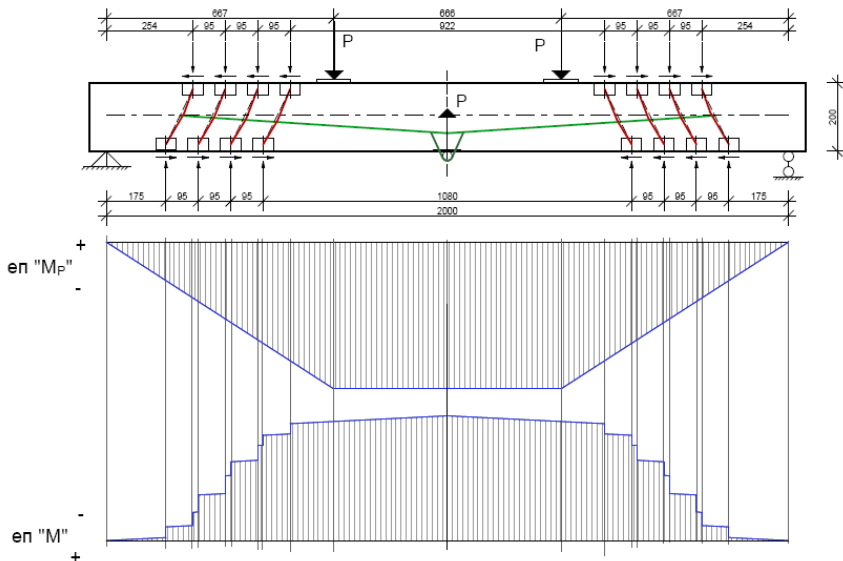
Регульовано напружена залізобетонна балка (варіант №1)
